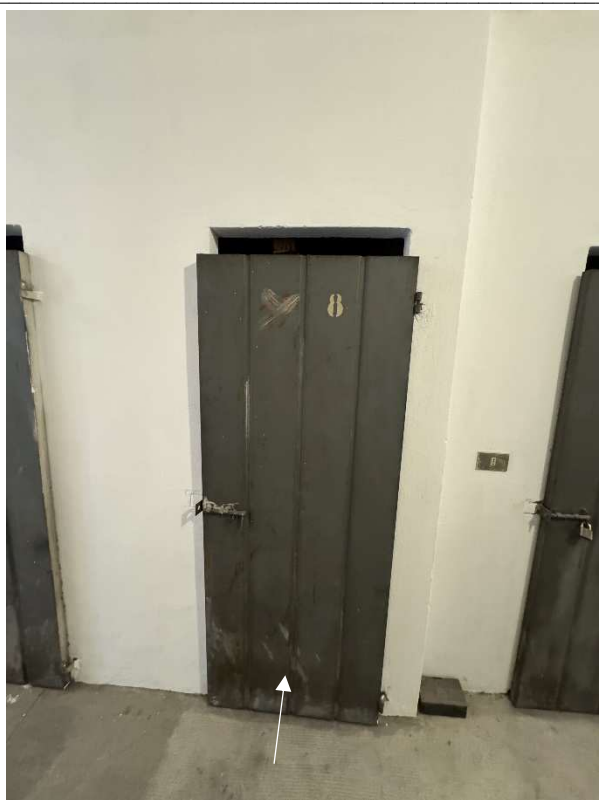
Piano Sesto (sottotetto). Corridoio comune e solaio
